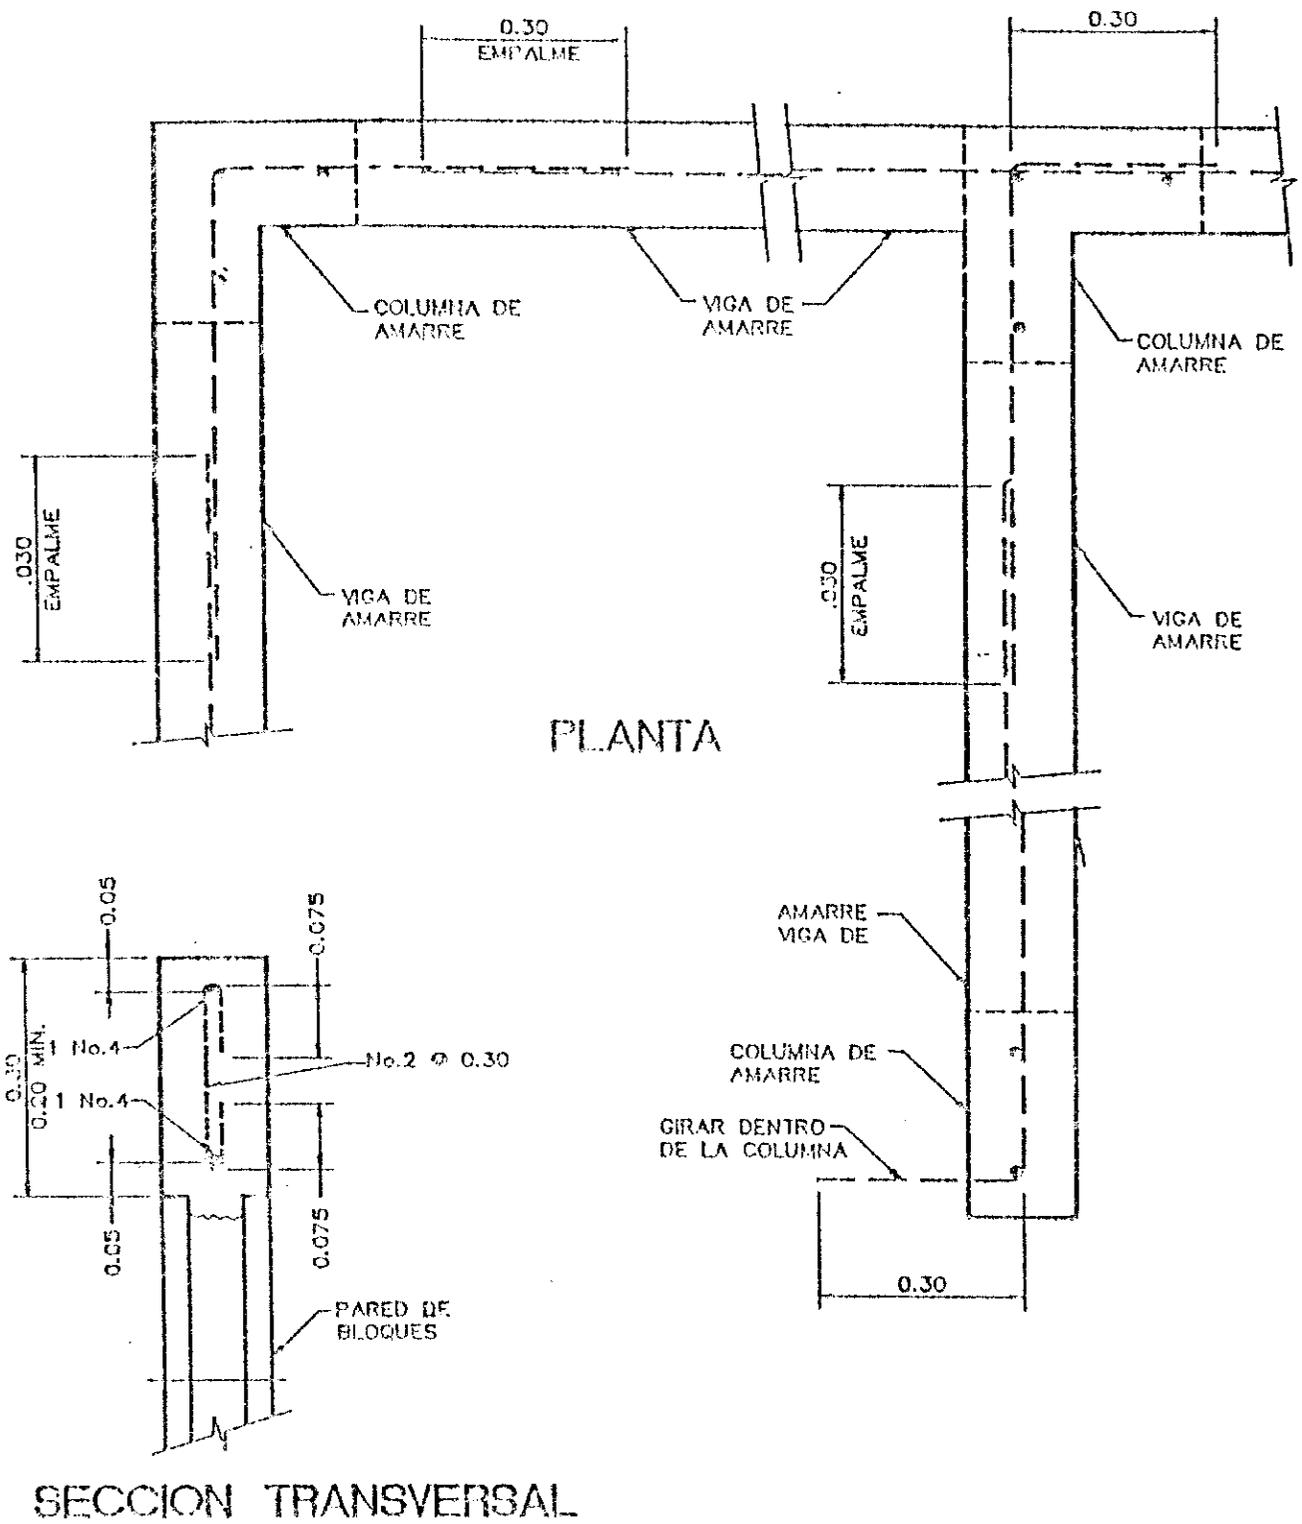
DETALLES TÍPICOS DE VIGAS DE AMARRE
